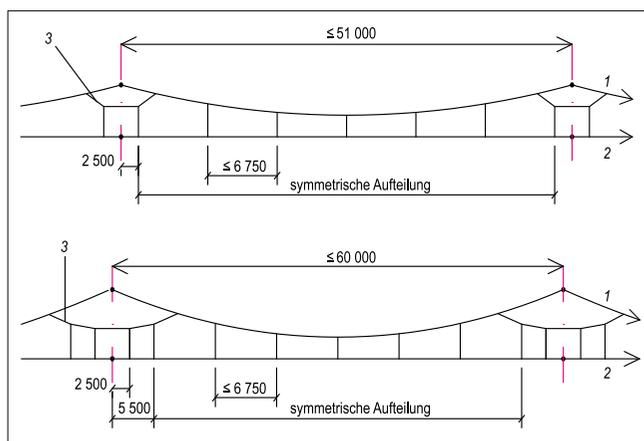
Drahtwerkschema einer Spannweite im Tunnel (oben) und auf der freien Strecke (unten).
